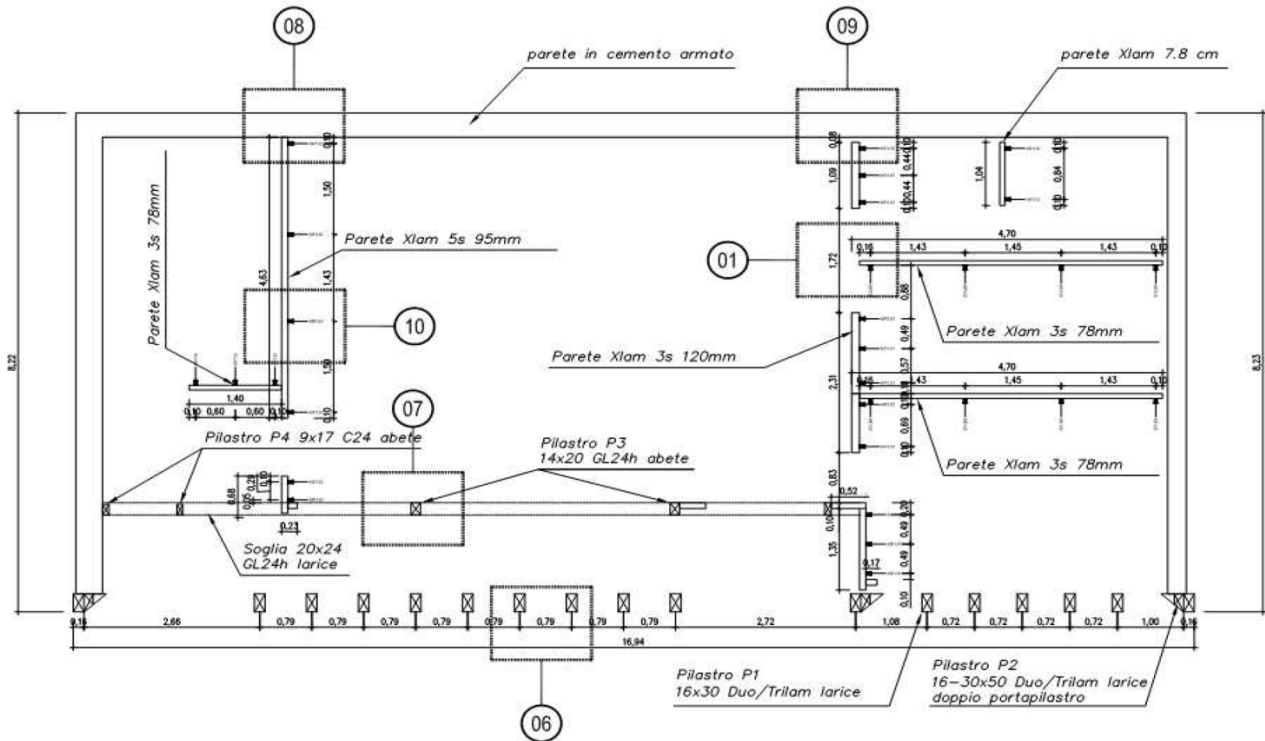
Pianta piano terra (progetto fornito dal progettista Arch. Mirko Franzoso)
